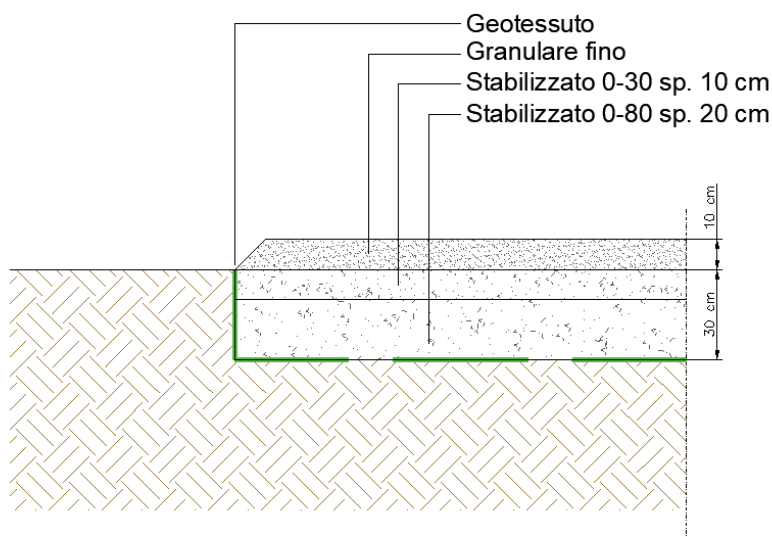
Sezione tipo viabilità interna all'impianto e piazzali (fonte: Relazione tecnica di progetto)
